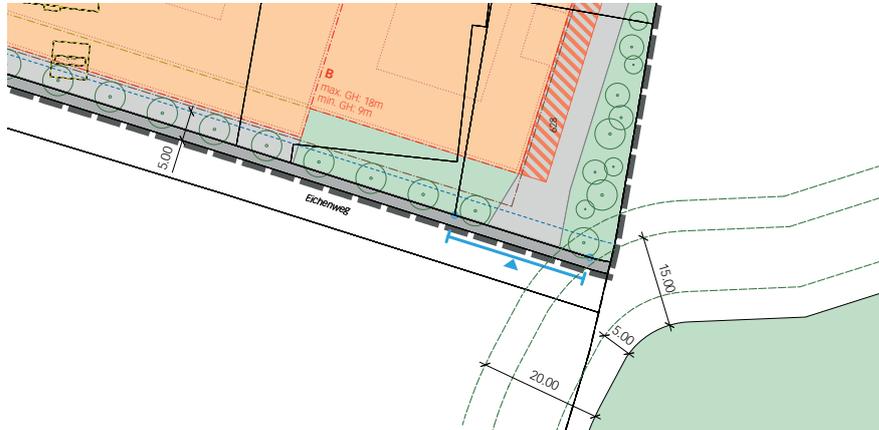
Ausschnitt Überbauungsplan mit Waldabständen
